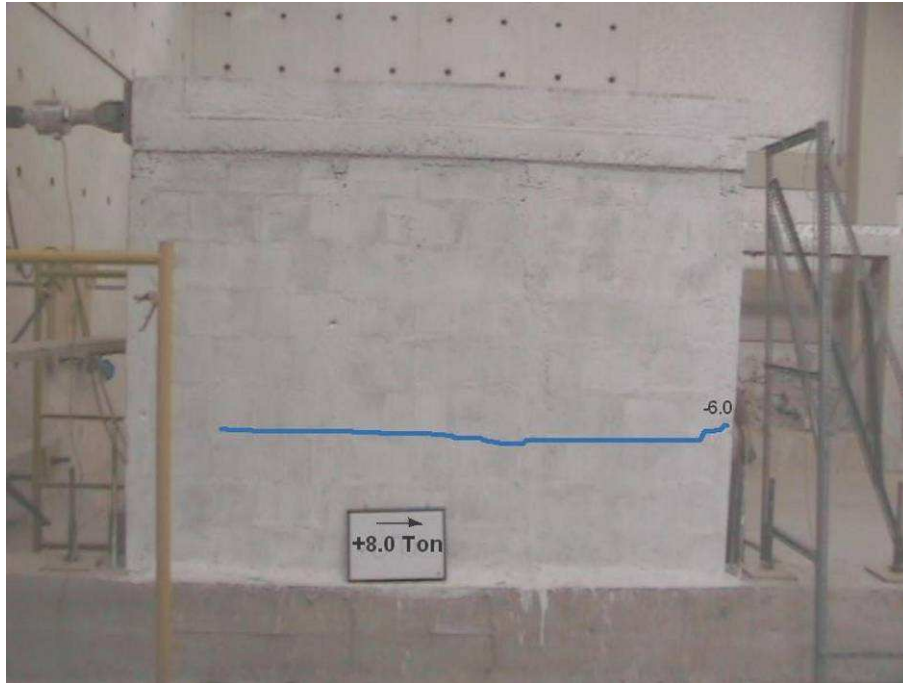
Fisuras en la pared a las 8.0 t de carga positiva
